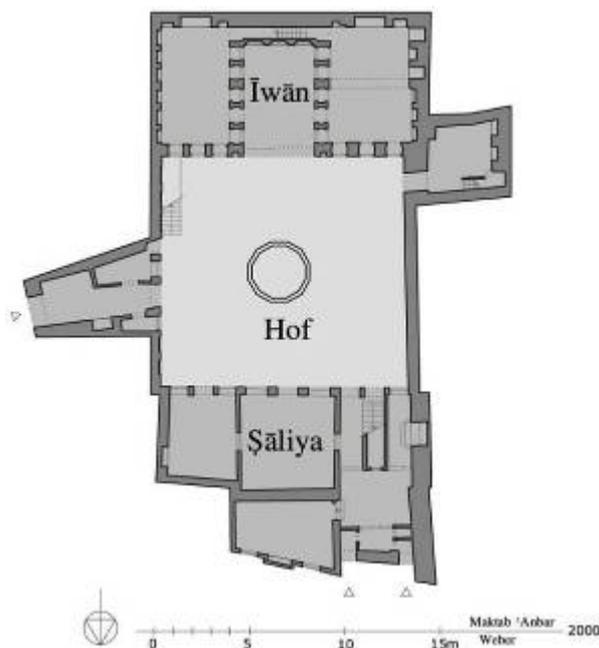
Bayt al-Ḥalabī, Grundriss EG
